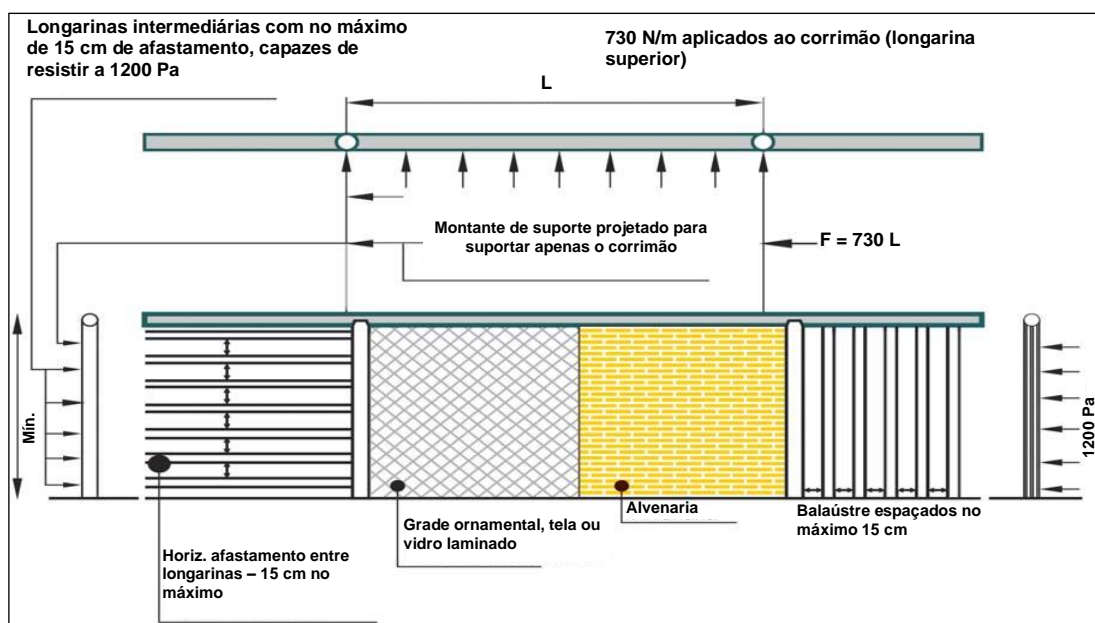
Pormenores construtivos da instalação de guardas e as cargas a que elas devem resistir
